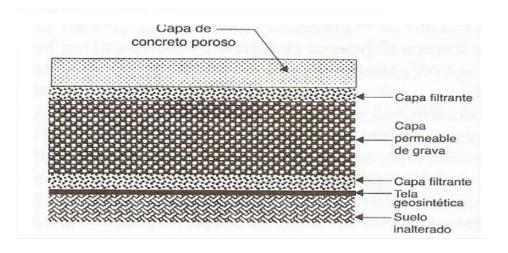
Capas que componen a un Pavimento Permeable.
